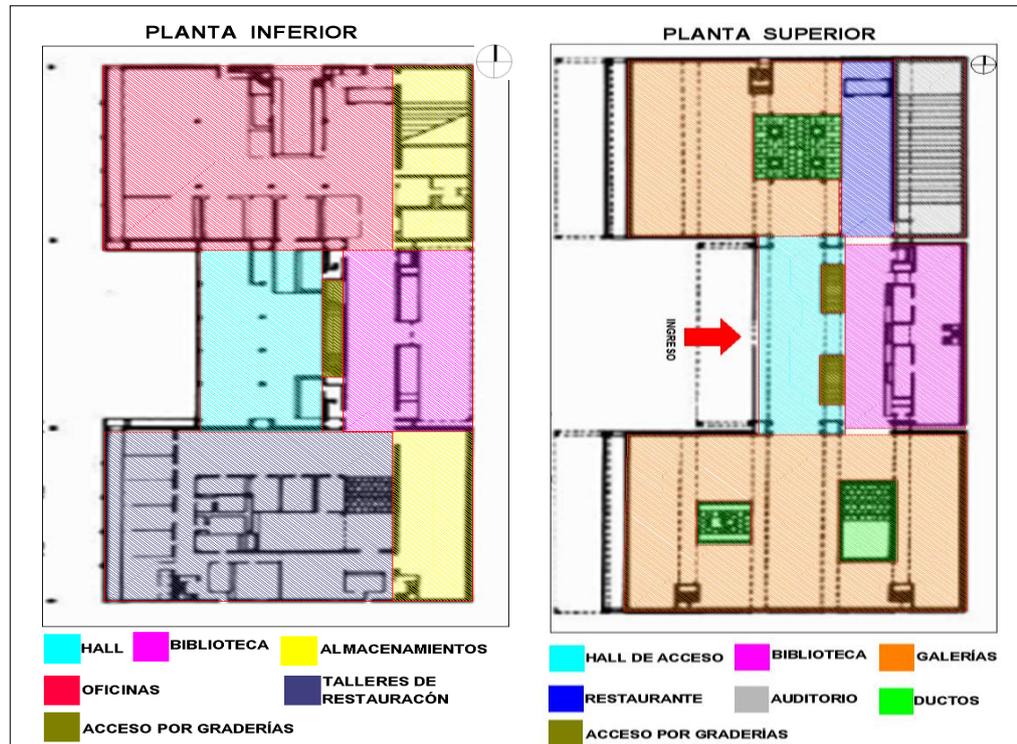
Esquema de zonificación planta inferior y superior del museo Kimbell.
